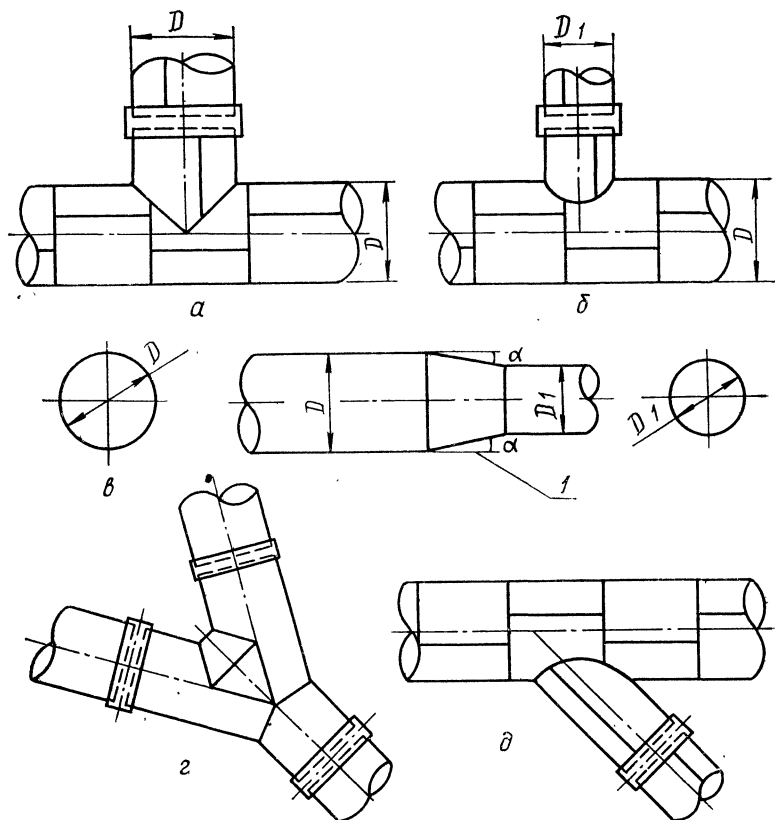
Схемы пересечений и переходов трубопроводов:
